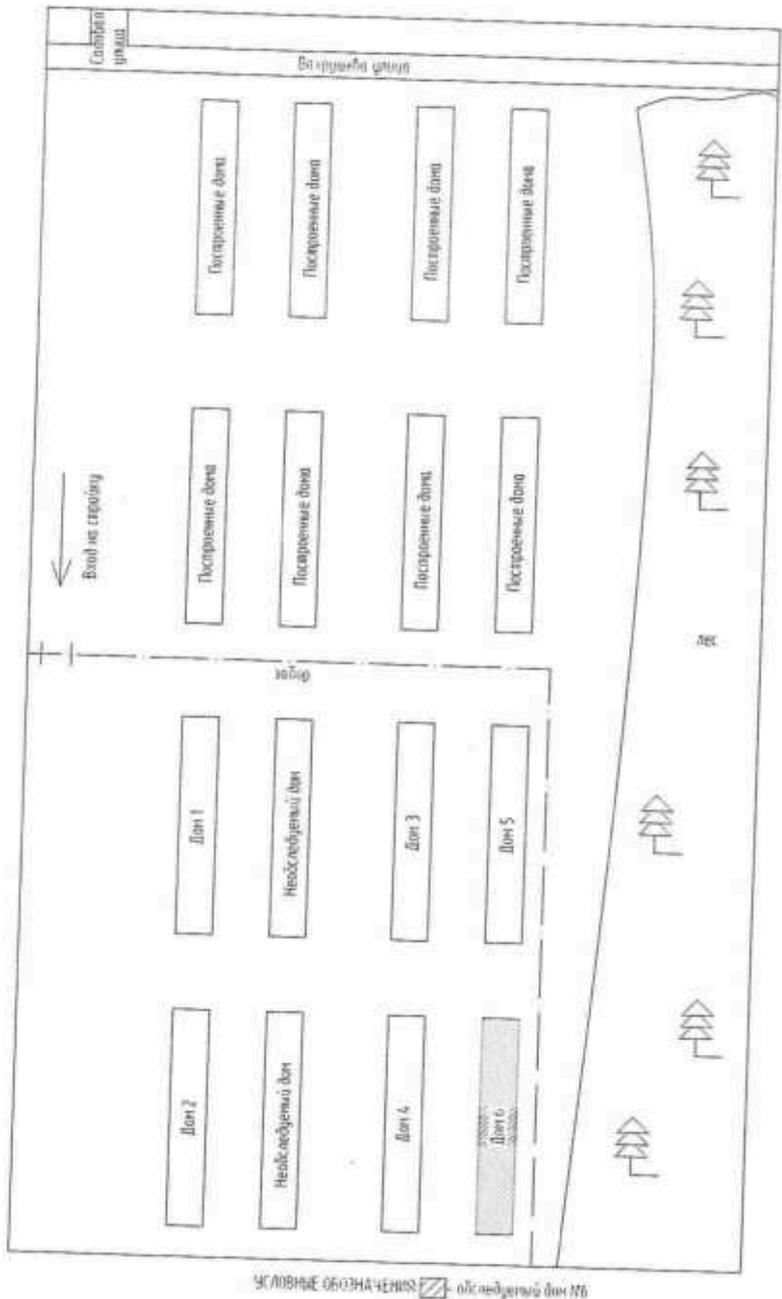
Условная схема расположения обследуемых зданий жилого комплекса "Березовая роща".
